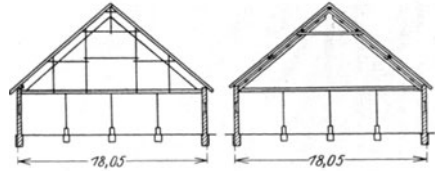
Binderformen für Dachgeschoßbauten; Zwei- und Dreigelenkbogen.
